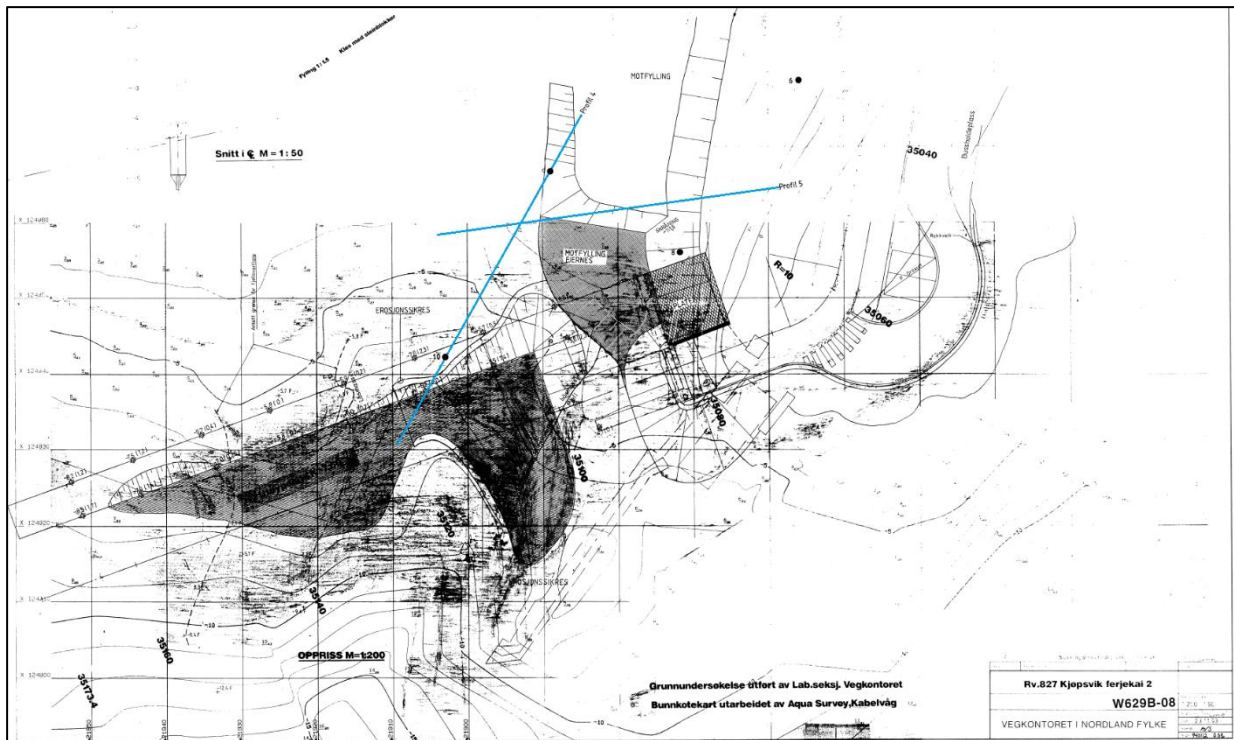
Planlagt motfylling profil 1 fra rapport W629B-1
